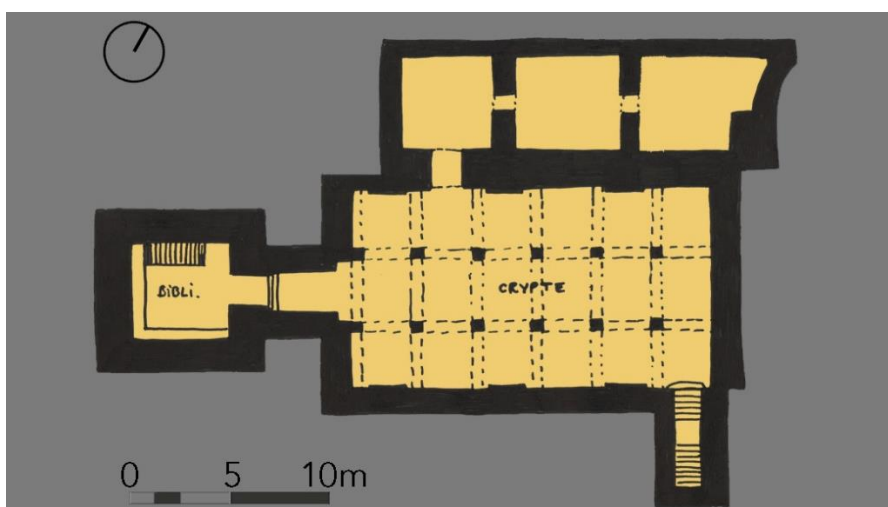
Plan de la crypte de l'église (fond de plan WalOnMap, 2016)
